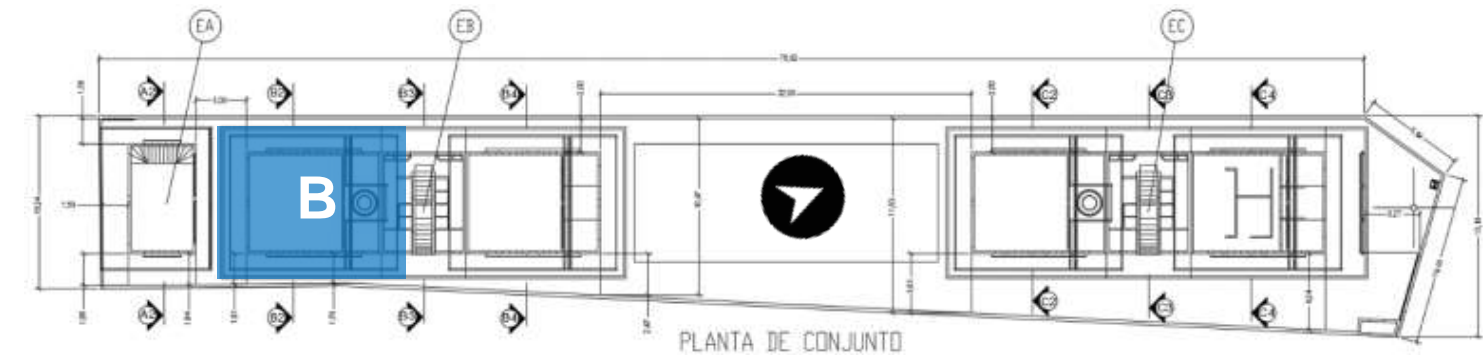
Caso de estudio Geometría solar del conjunto arquitectónico de anteproyecto. Fuente: Elaboración propia.
